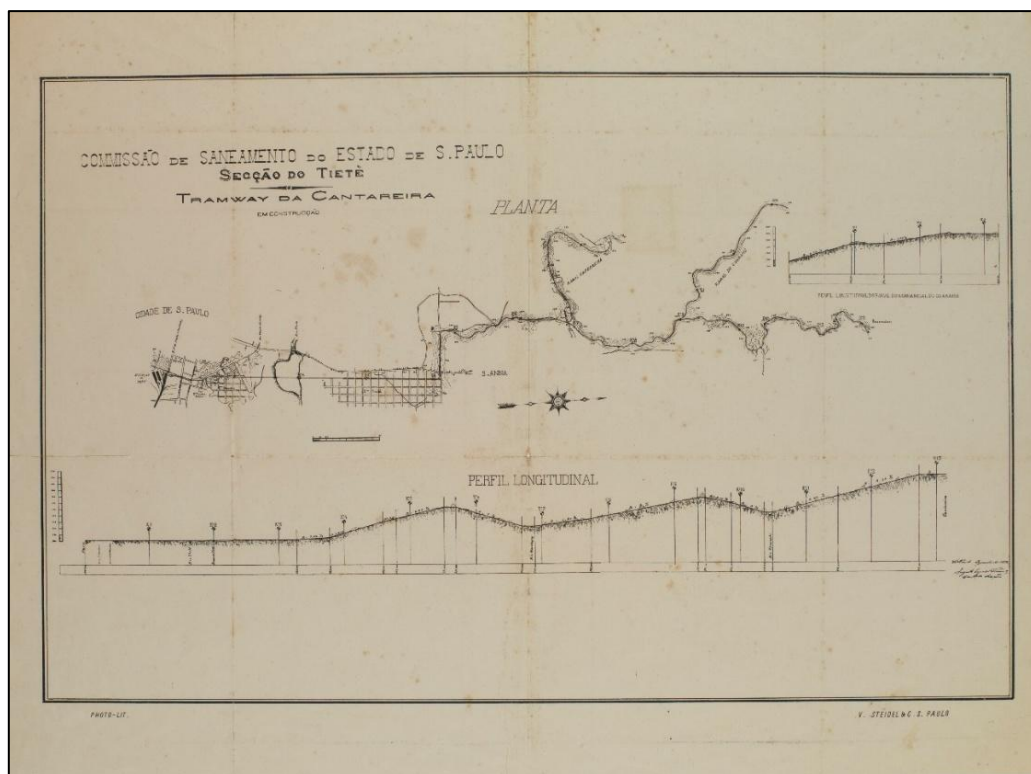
Planta da Comissão de Saneamento do Estado de S. Paulo, seção Tietê, *Tramway da Cantareira* em Construção. 1893. Fonte: Arquivo do Museu Paulista da USP.
